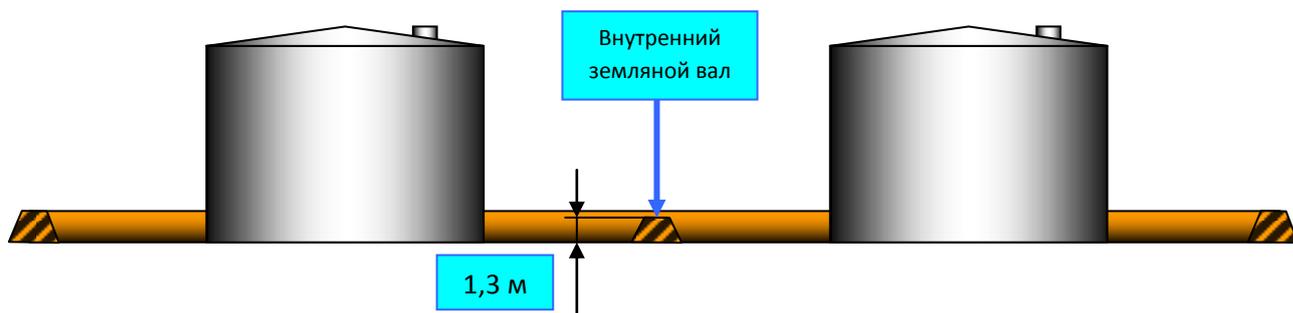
Схема земляного вала для резервуаров более 20000 м³
